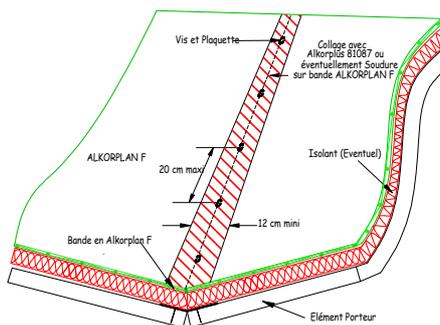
Soudure en noue sur bande alkorPLAN F
